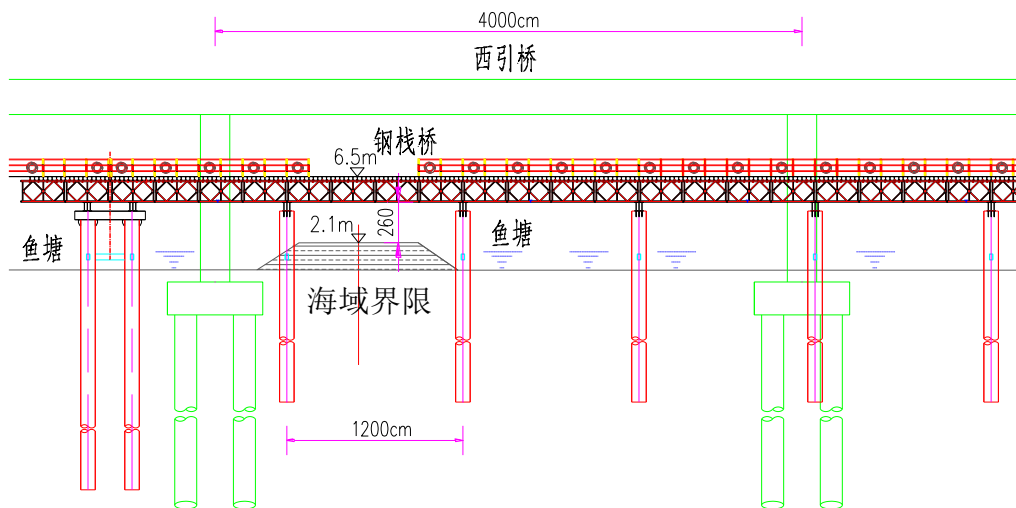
穿越西岸台山侧海域界限平面图
